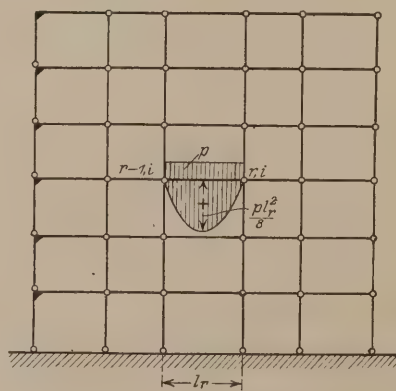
Momentenfläche infolge Belastung der Öffnung  $(r-1, i) - r i$  im Grundsystem.
